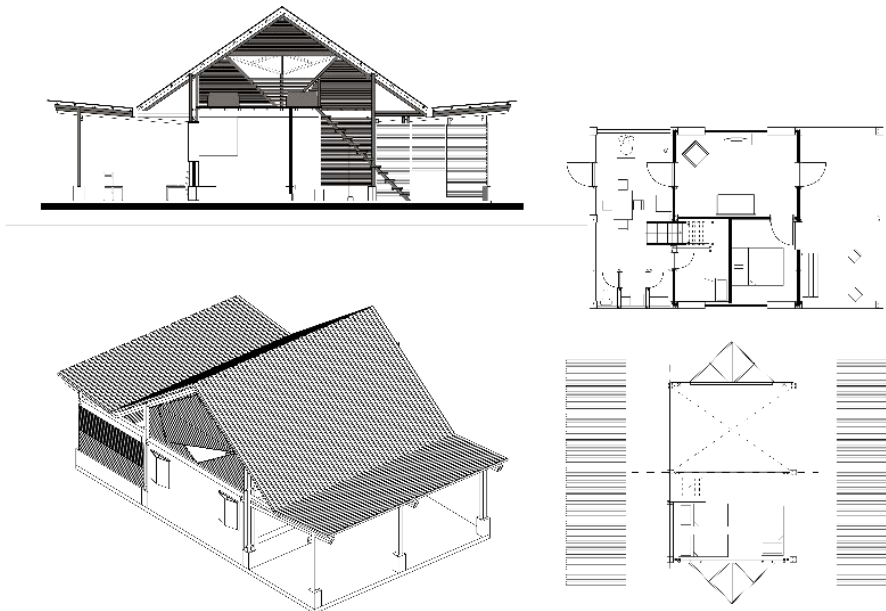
Proyecto arquitectónico (plantas, cortes y volumetría). Fuente: Elaboración propia a partir de: Lucila Aguilar arquitectos, 2018.
